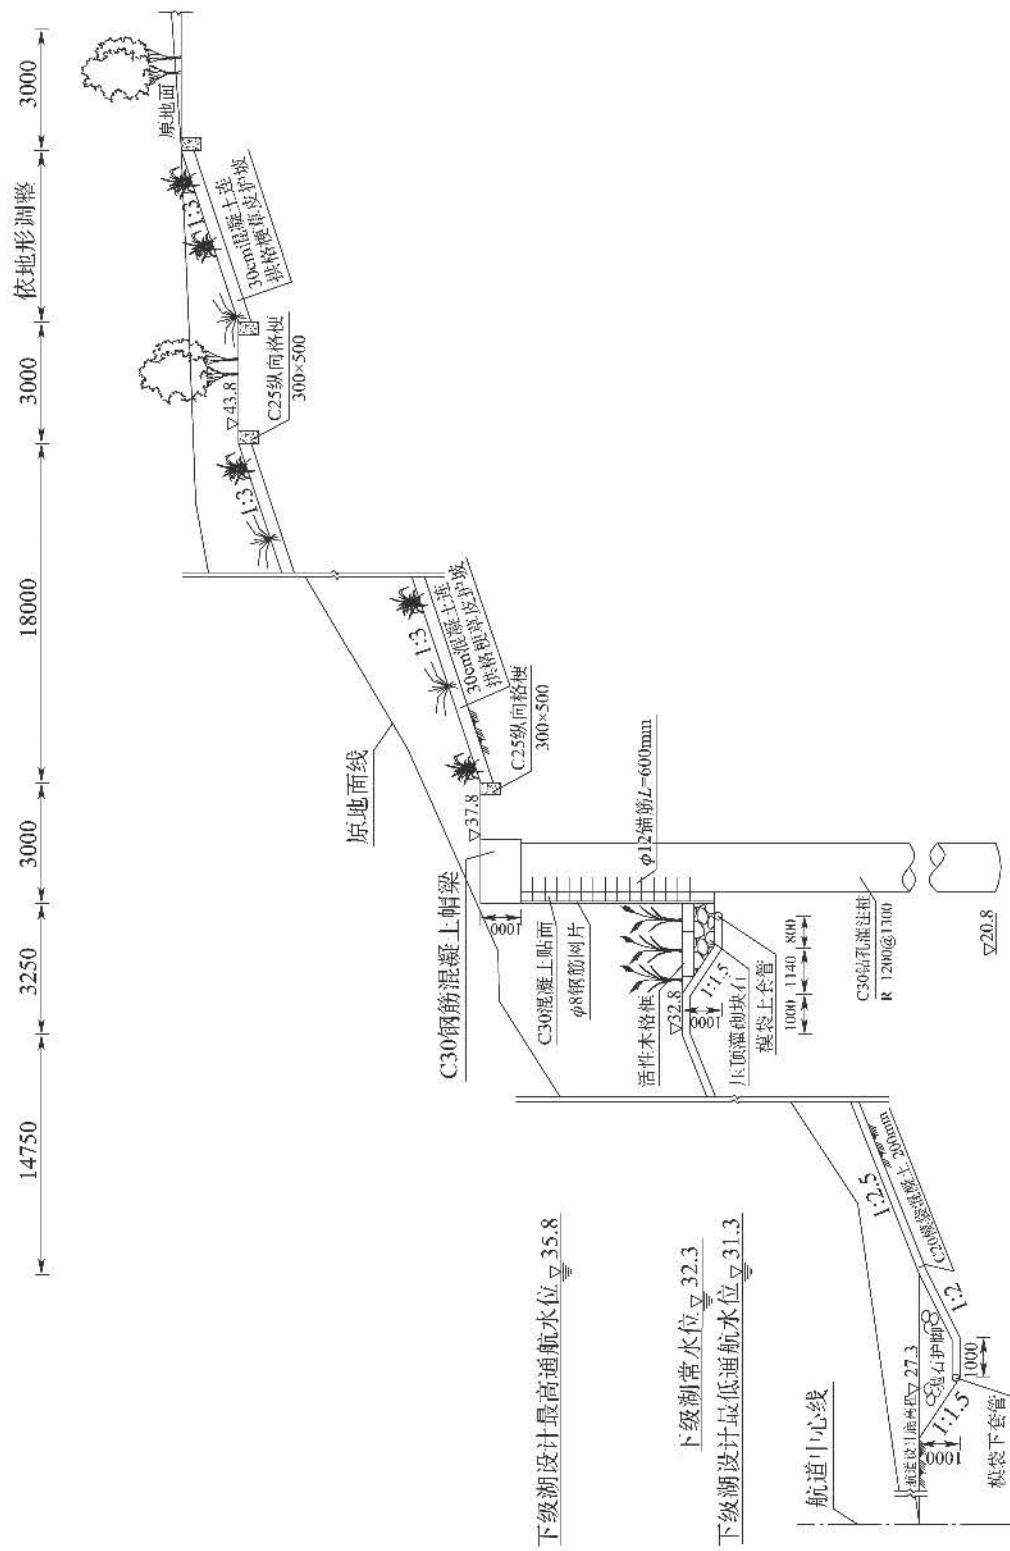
航道整治工程-华东某运河航道整治工程-3#护岸断面示意图(尺寸单位:mm;高程单位:m)
